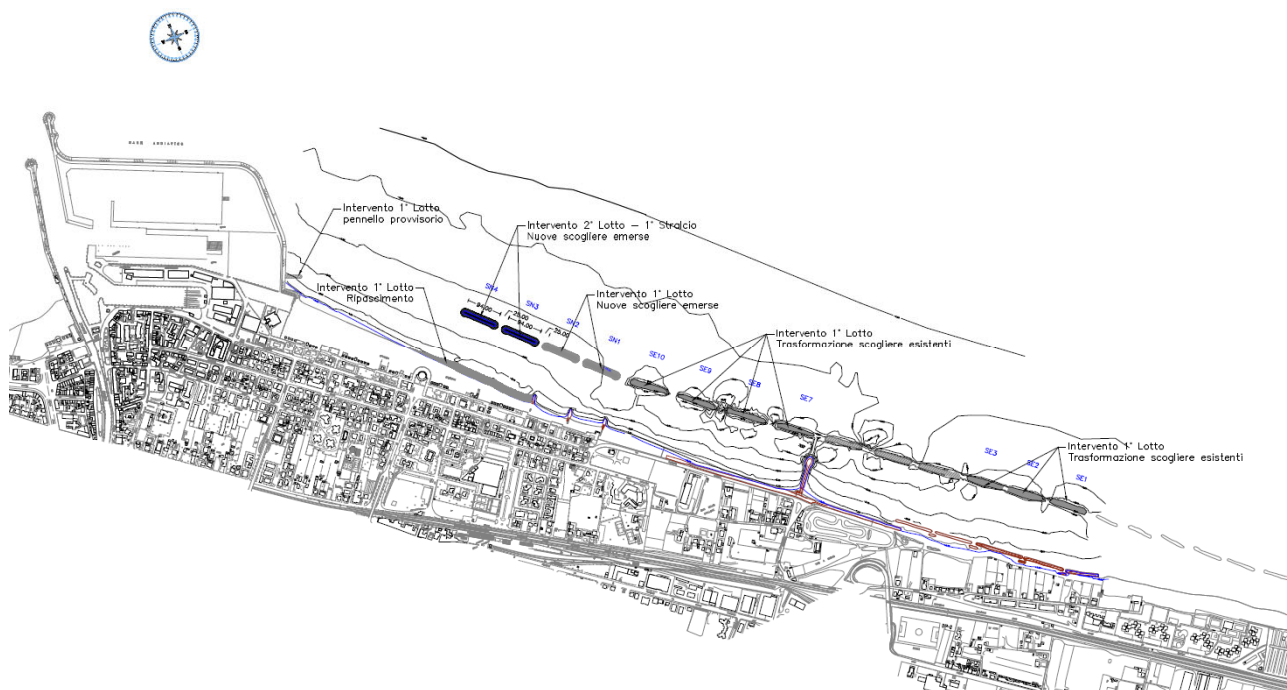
Stralcio della planimetria di Progetto – 1° e 2° lotto
